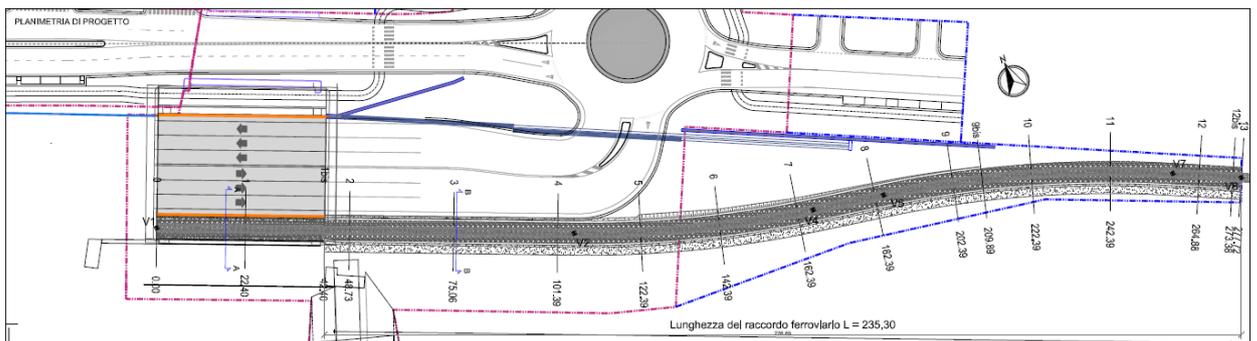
Planimetria opere previste nell'Ambito 1 (fonte: Elaborato FS.05.01 – AMBITO 1: “Opere Ferroviarie - Stato di progetto”)
